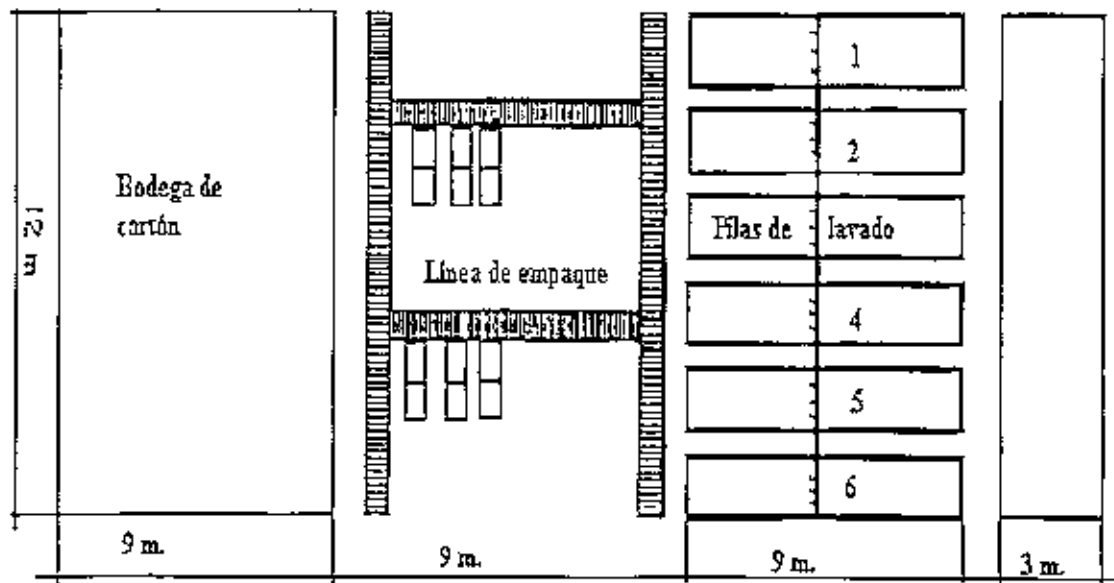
Esquema de una planta empacadora (Soto, 1985)
